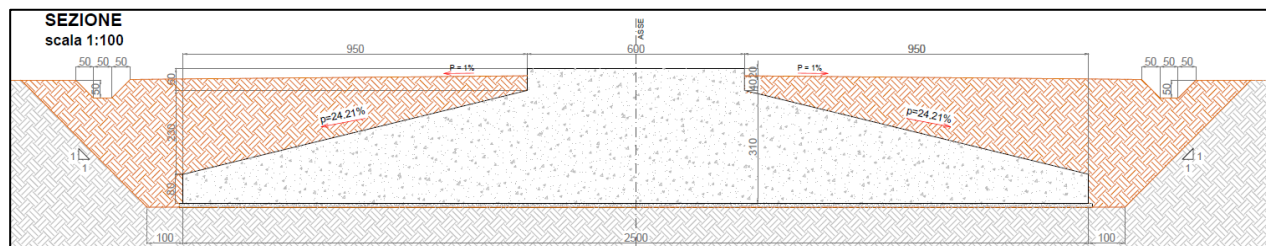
Geometria della fondazione diretta dell'aerogeneratore
